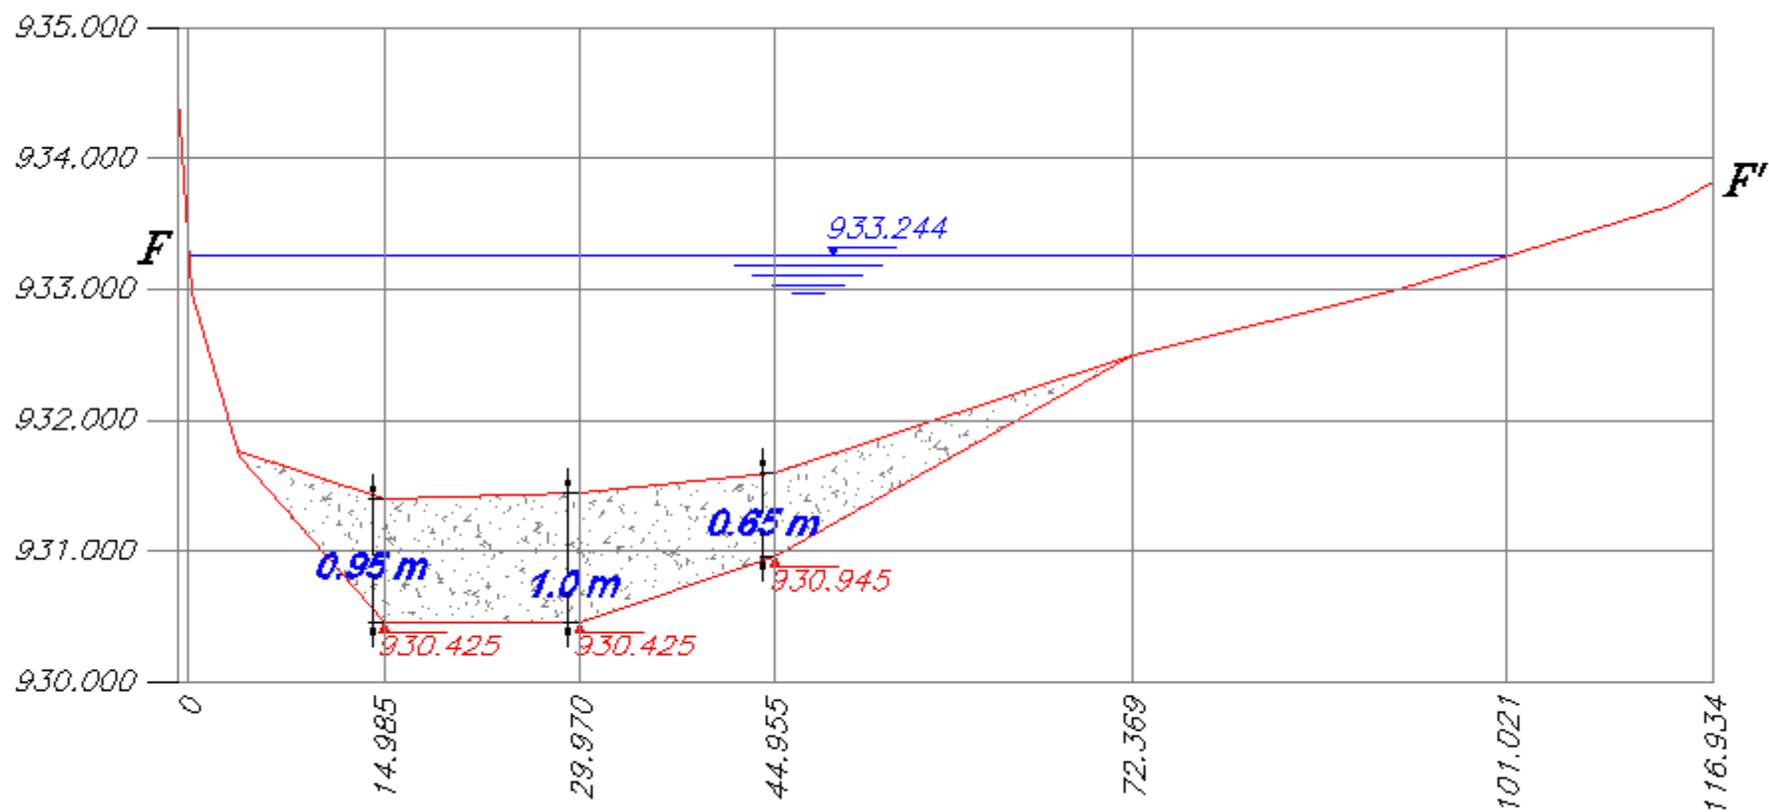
Perfil F – F' Madre Vieja Carabalo.
